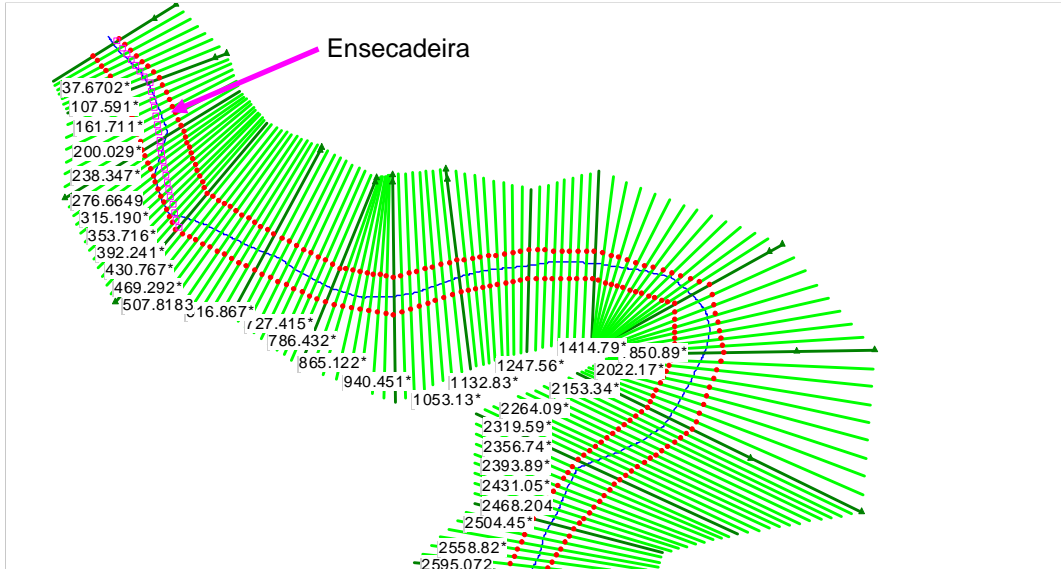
Posicionamento aproximado da ensecadeira junto a área de construção da barragem Taquarembó
